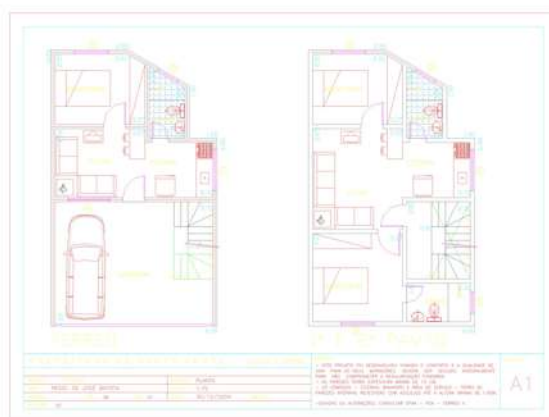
Projeto de autoconstrução - José Batista (3 aptos) – Setor 1
